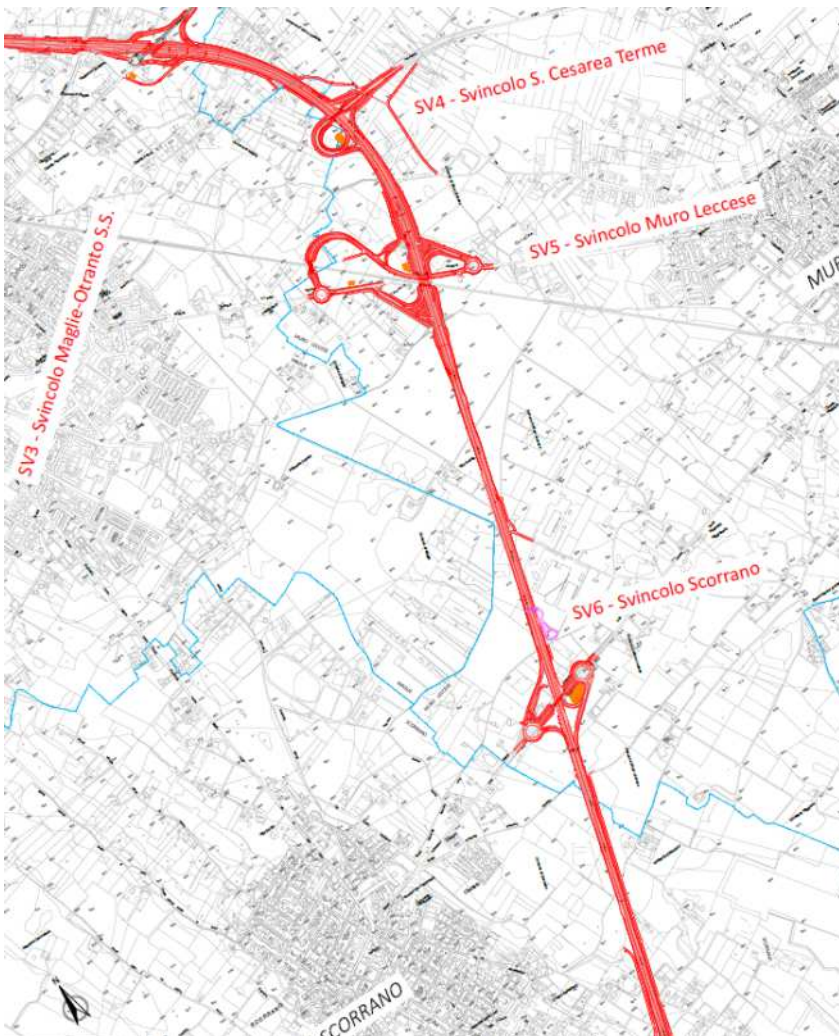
Planimetria complessiva dell'intervento su base CTR – 2 di 5
